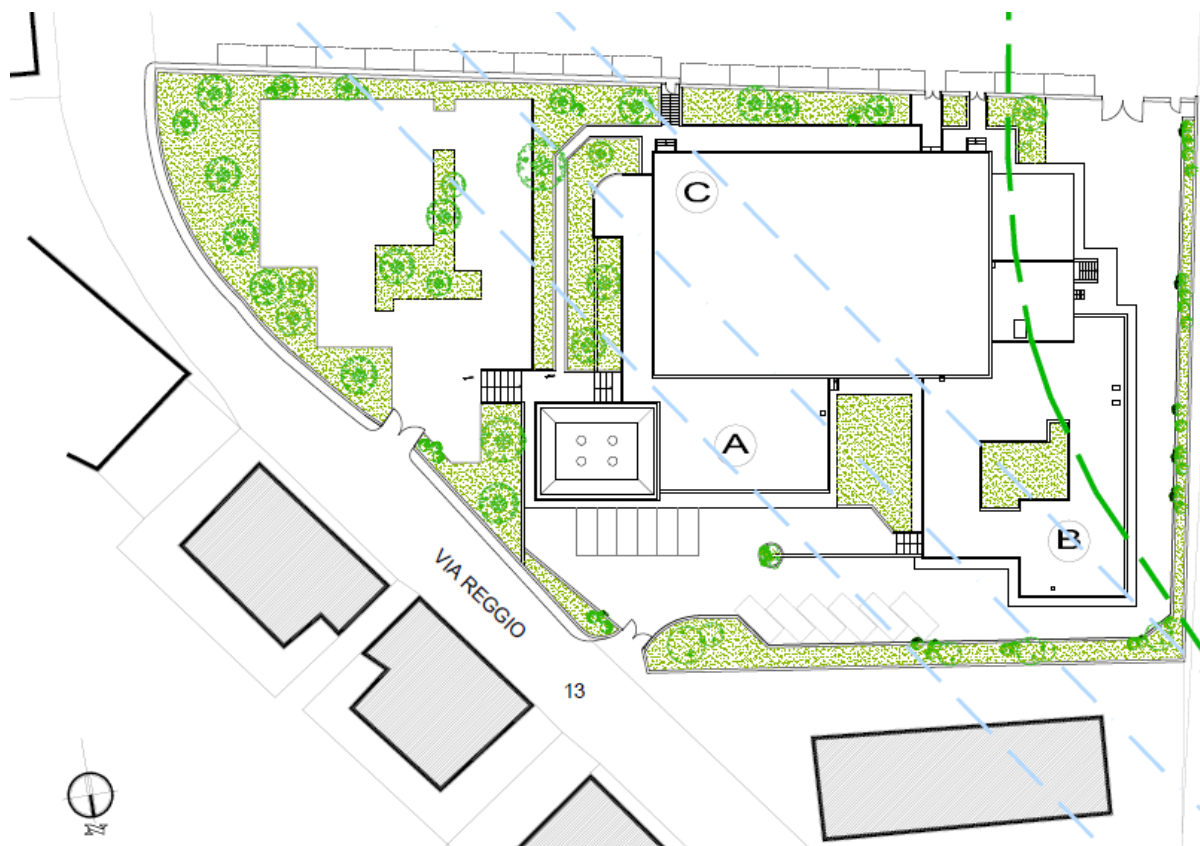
Planimetria generale con indicazione dei corpi di fabbrica A, B, C e D
